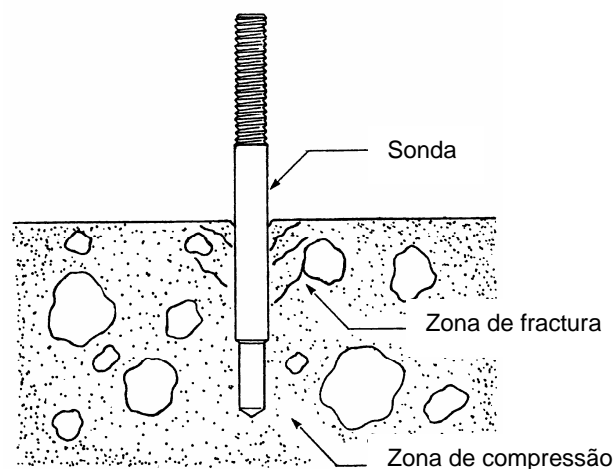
Rotura típica de um betão endurecido após penetração da sonda [64]
